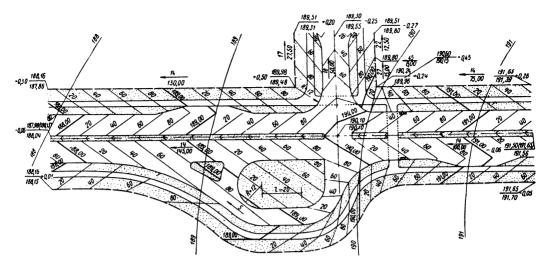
Пример вертикальной планировки примыкания одной улицы к другой (T-образный перекресток)
